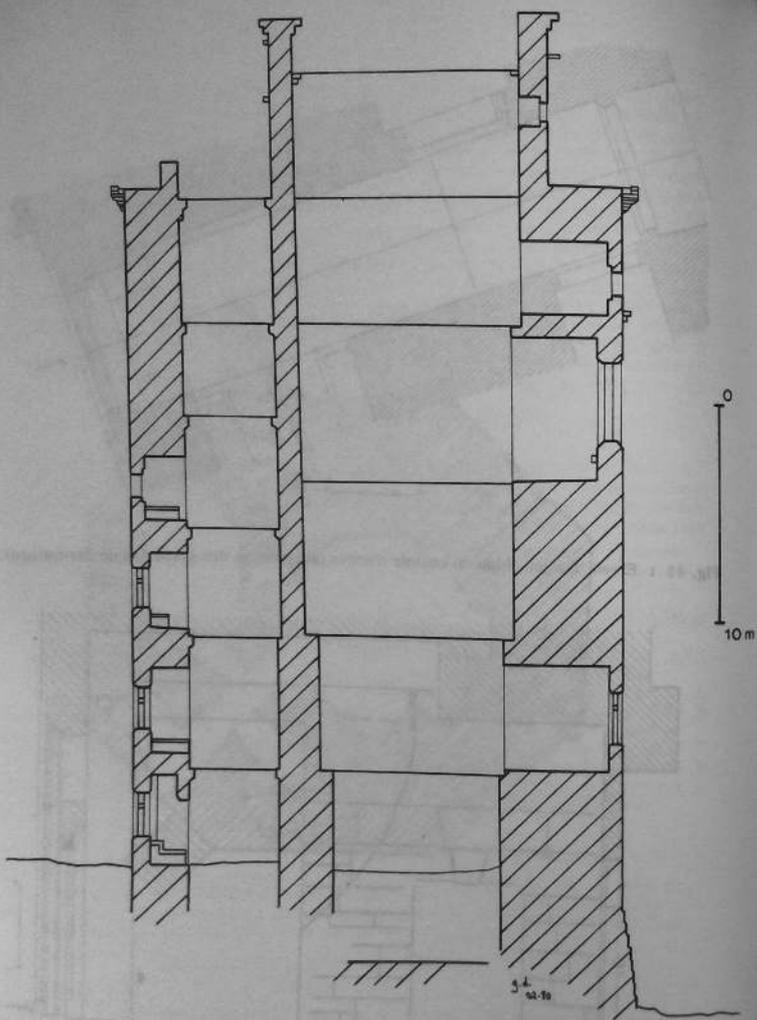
Elven. Donjon. Coupe ouest-est.
